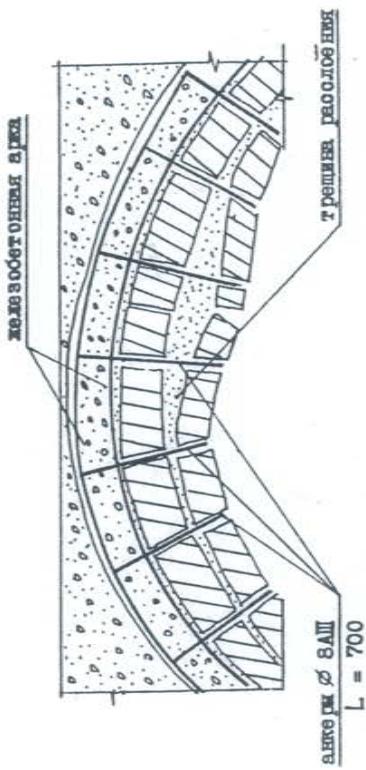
Укрепление деформированных сводов дублирующими арочными элементами
